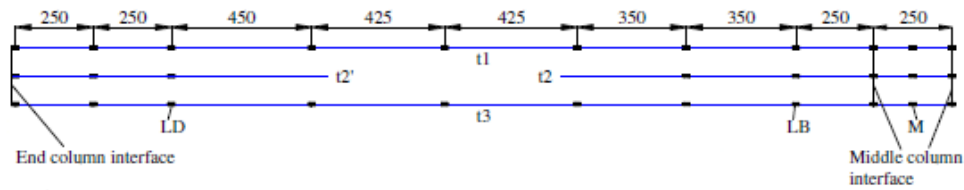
Localização dos extensómetros (secções LD, LB e meio vão) – adaptado de (Yu and Tan, 2013)
